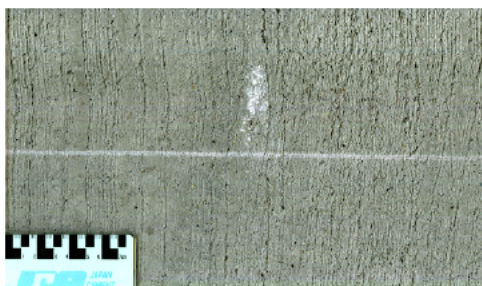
配合 No. 1, 提案工法 1, IWP
